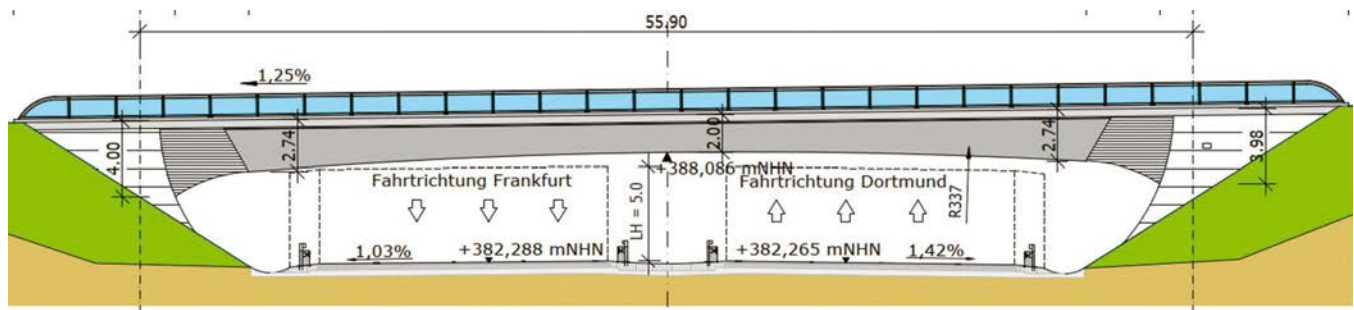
Variante 2 – Spannbetonbrücke als Rahmentragwerk in Ort beton
